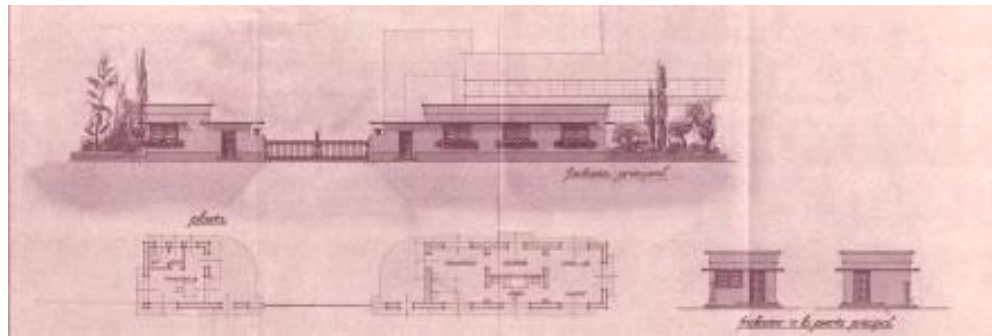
Plantas y alzados del proyecto de la portería y el botiquín. (AMV 1942)
